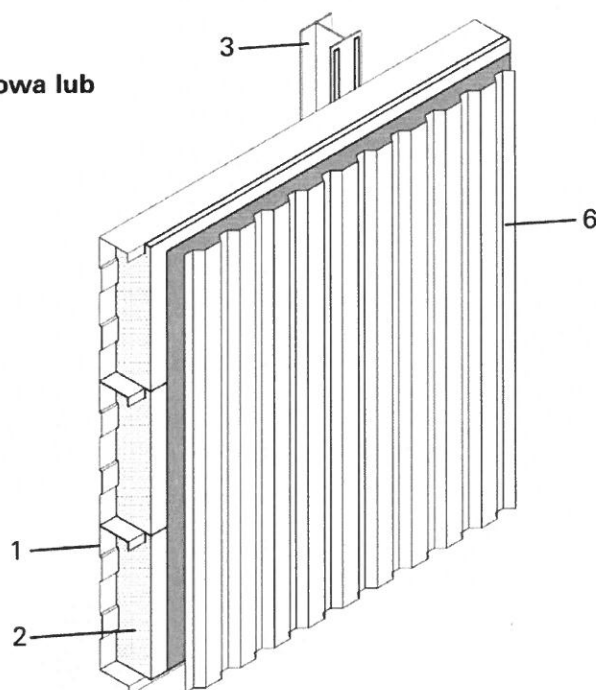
Schemat budowy ściany – ściany z elewacją ze paneli elewacyjnych
